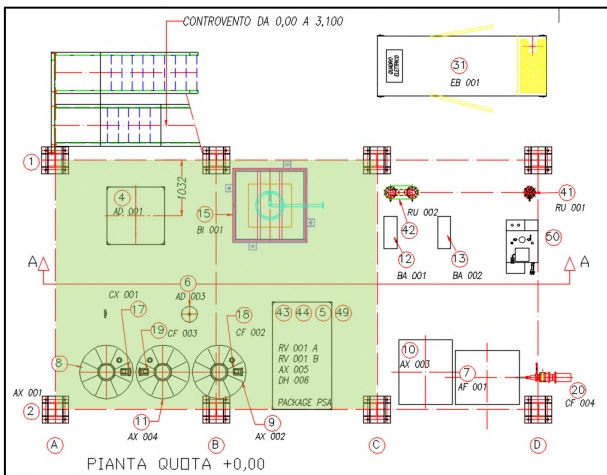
Pianta dell'area dell'impianto a quota 0.
